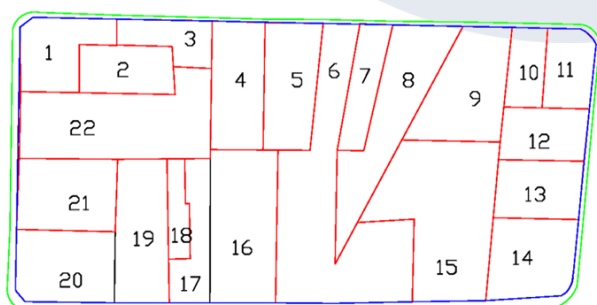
Ejemplo obtención \u00e1rea edificada en planta baja
